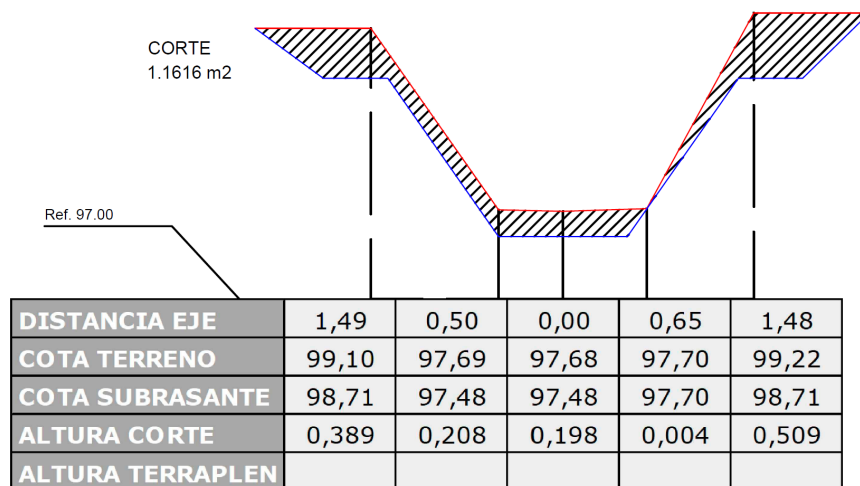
Perfil Transversal N°9 (Fuente Propia)
